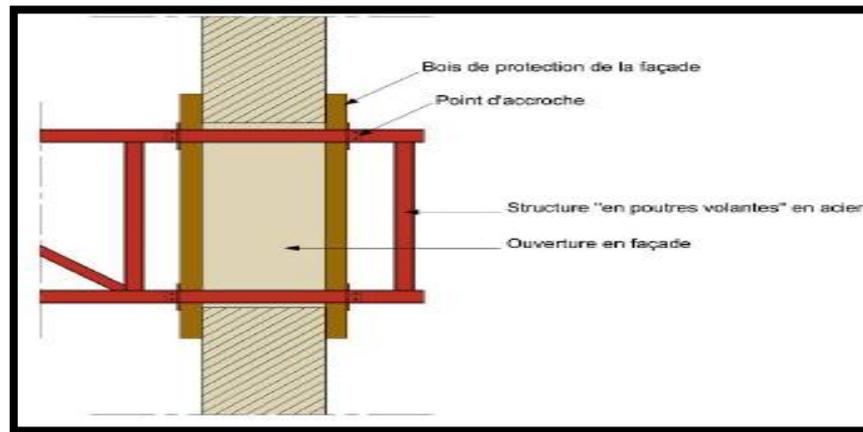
exemple de détail de fixation des poutres aux fenêtres
